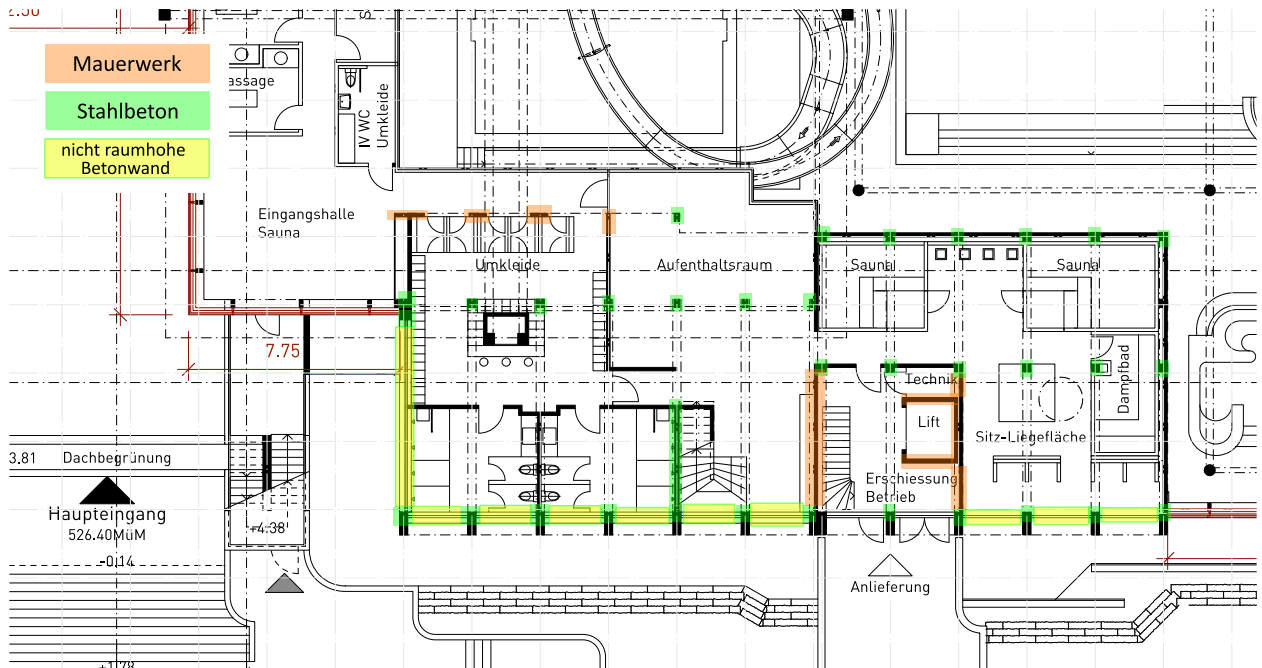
Modellerte tragende Elemente Sauna im 1. Obergeschoss
